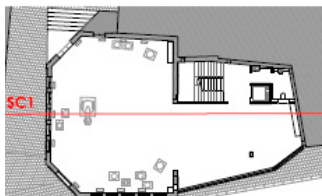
Sección transversal (Arquitectura Genís Planelles).
